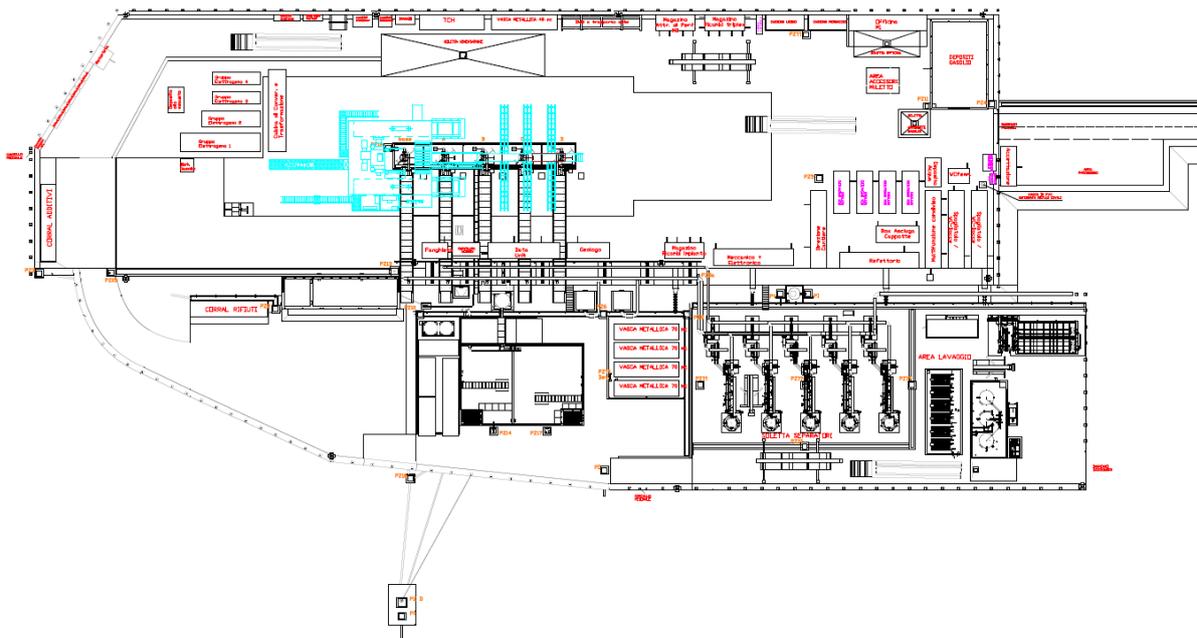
Layout standard impianto di perforazione MASS 6000
